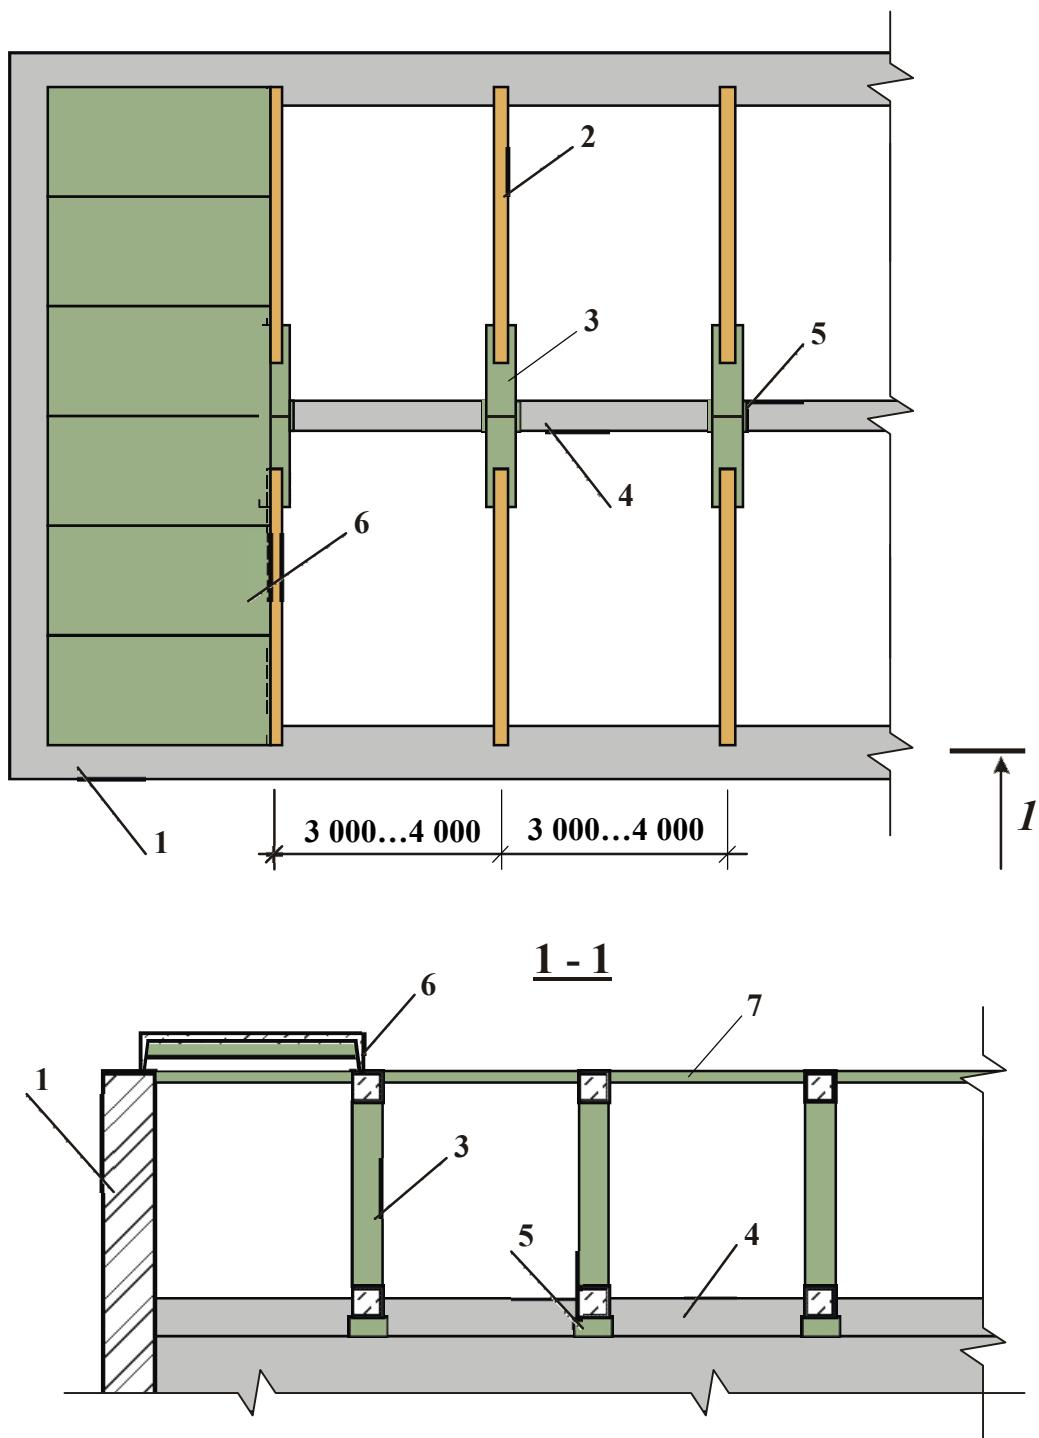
Дах із ребристих залізобетонних панелей, кроквяних ферм і ніг: 1 – стіна; 2 – кроквяна нога; 3 – ферма; 4 – розпірне цегляне мурування (не менше двох рядів); 5 – опорна подушка; 6 – панель покриття; 7 – розпірка залізобетонна
